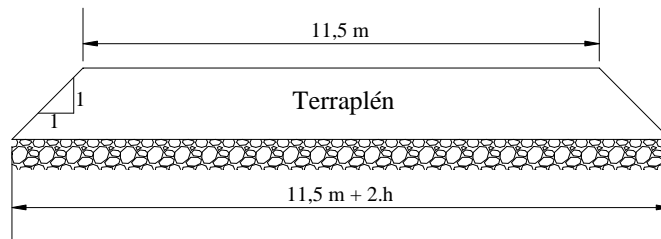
Perfil Tipo para el Tramo N°1
